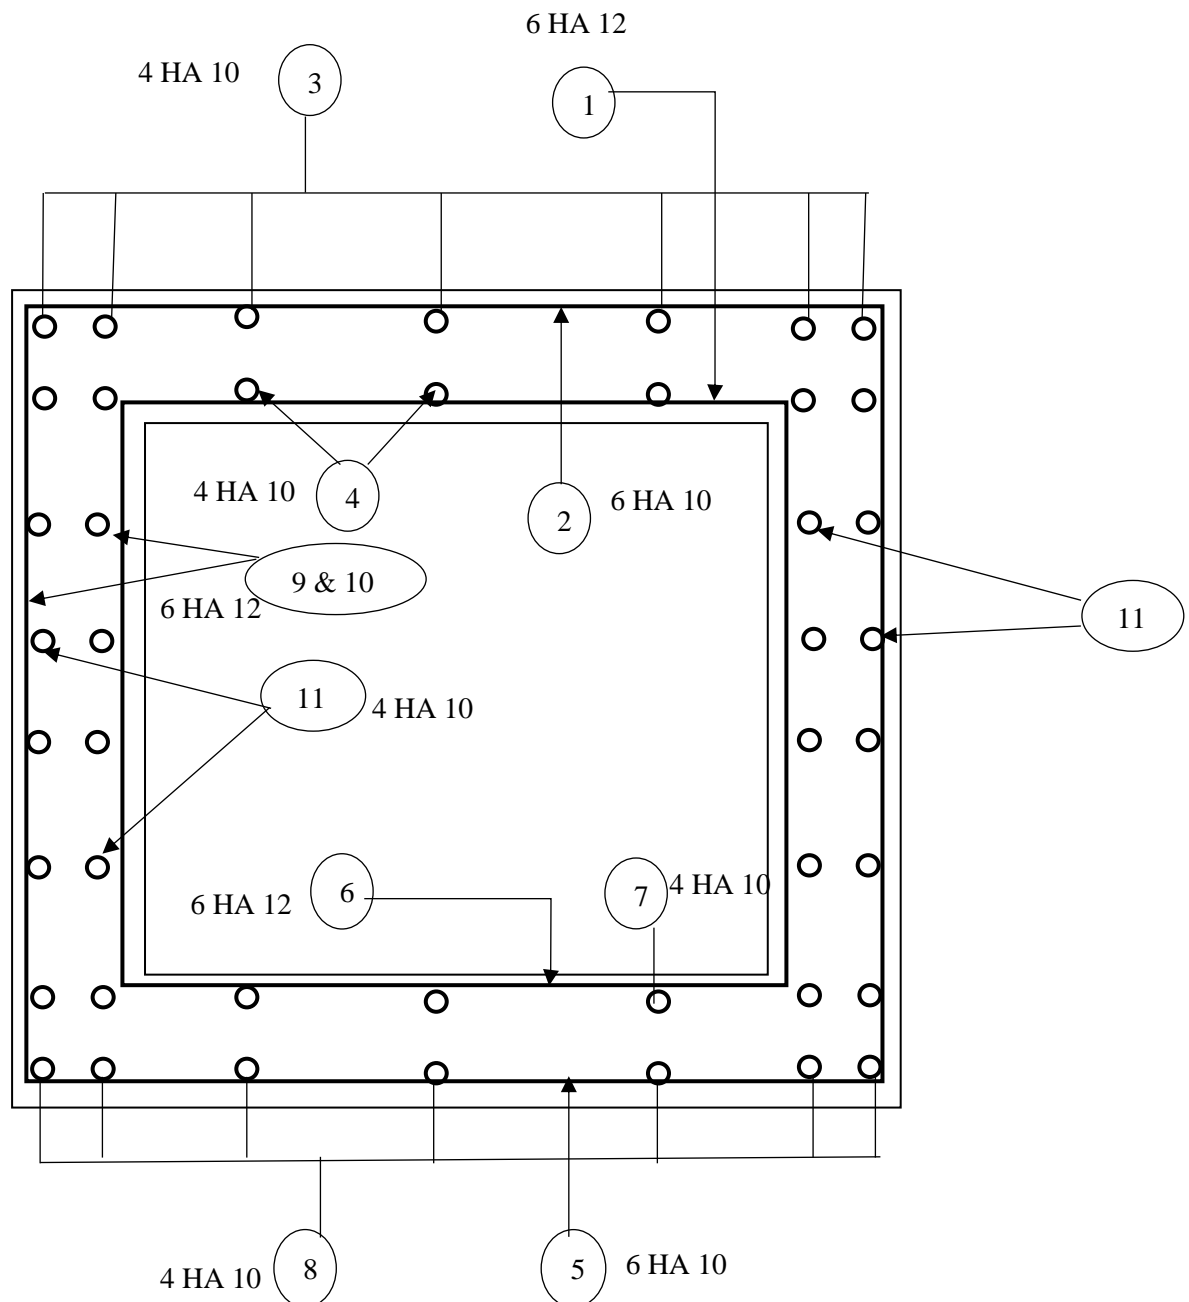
Vue montrant la coupe transversale de ferrailage du Caniveau 80x80
